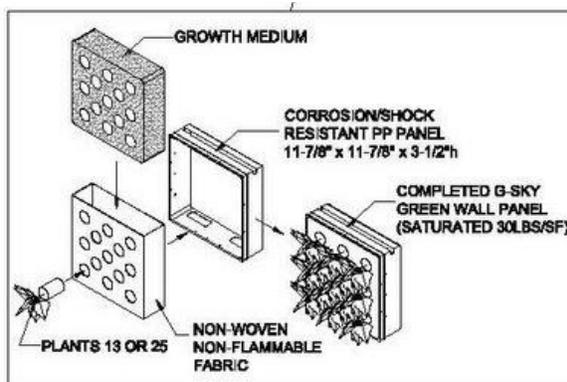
Sistema G-Sky, Pro wall systems y Versa wall system. Fuente: <http://gsky.com>
